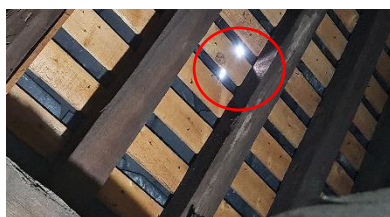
Bâtiment central, trou dans la toiture versant sud entre les fermes 12 et 13
